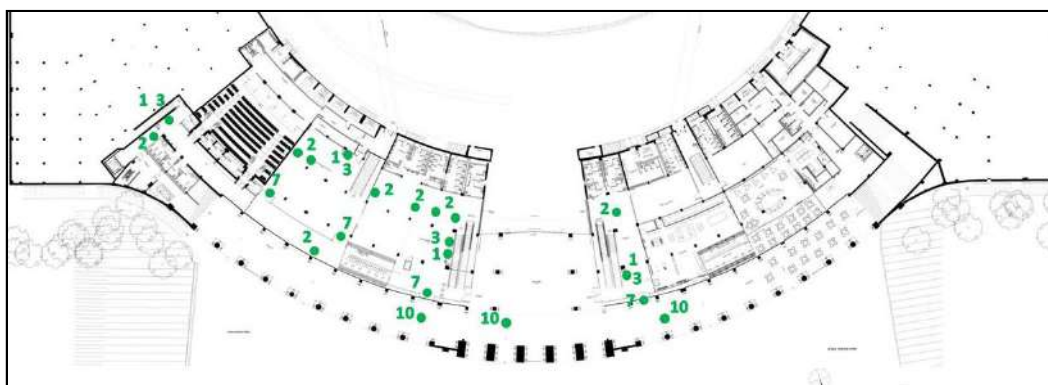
Planta Pavimento Térreo - Pontos de aplicação: checklist de segurança e proteção contra incêndio
